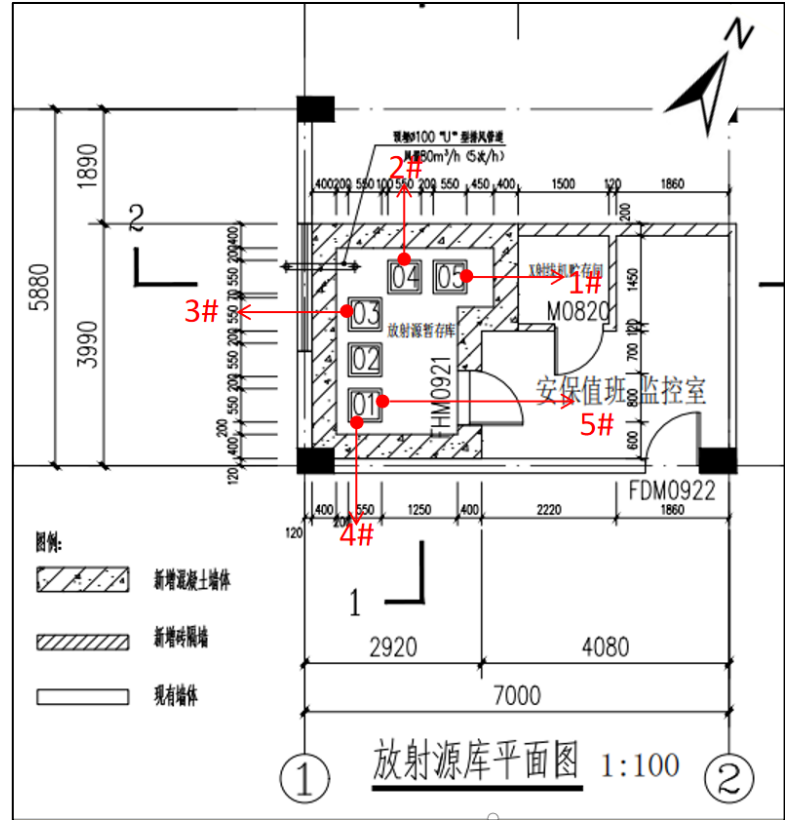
放射源暂存库平面布局及预测点位示意图（单位：mm）
